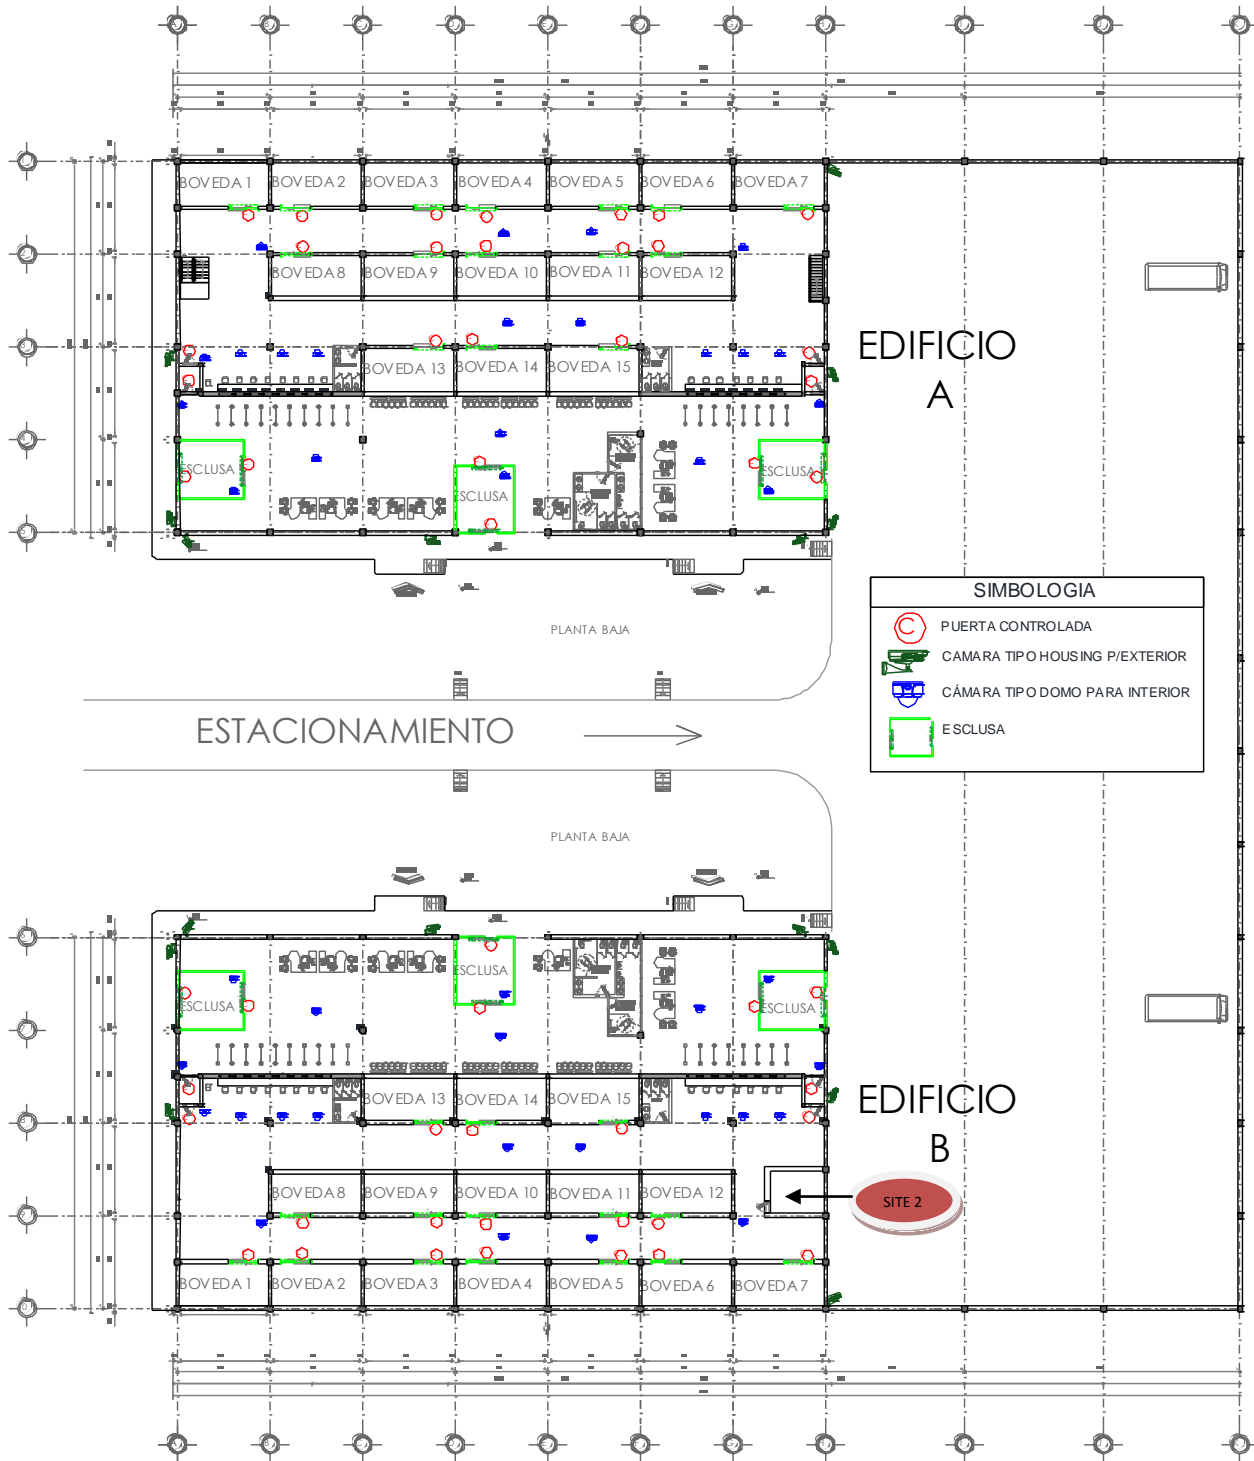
Sembrado de Equipos Planta Baja Edificio A y B.
